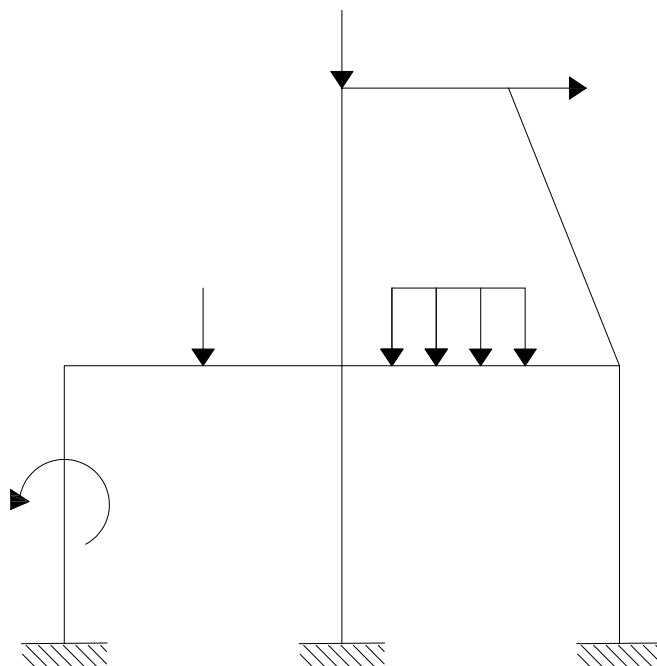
Pórtico Plano - Fonte: Ribeiro (2016)
